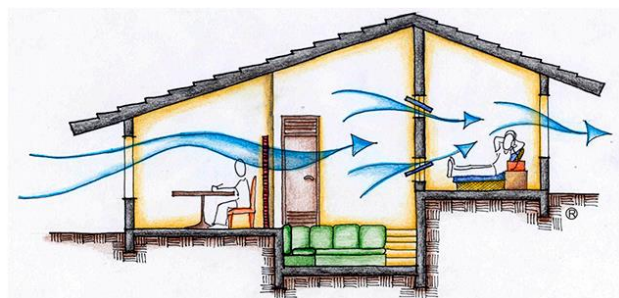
Ventilação cruzadas - Plantas abertas[10]
